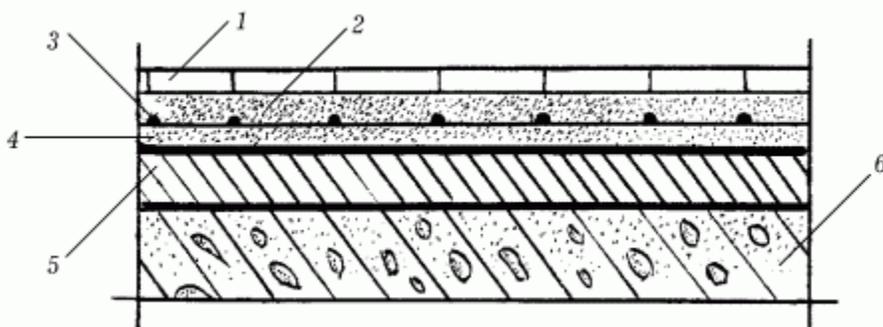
Теплый пол с керамической плиткой: 1 – паркет (полипокрытие, керамическая плитка); 2 – утеплитель; 3 – греющий провод в цементной стяжке (1–2 см); 4 – гидроизоляция, экран из фольги; 5 – пароизоляция; 6 – плита перекрытия.
